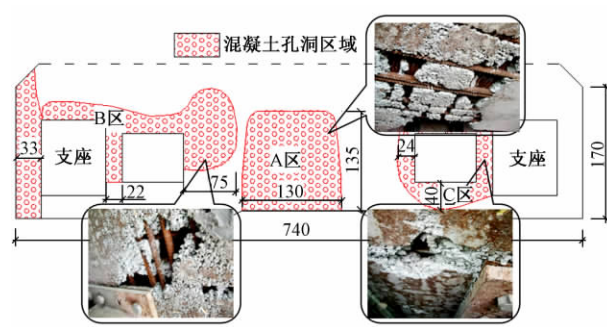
某桥 0#块底板混凝土缺陷展示意(单位:cm)
